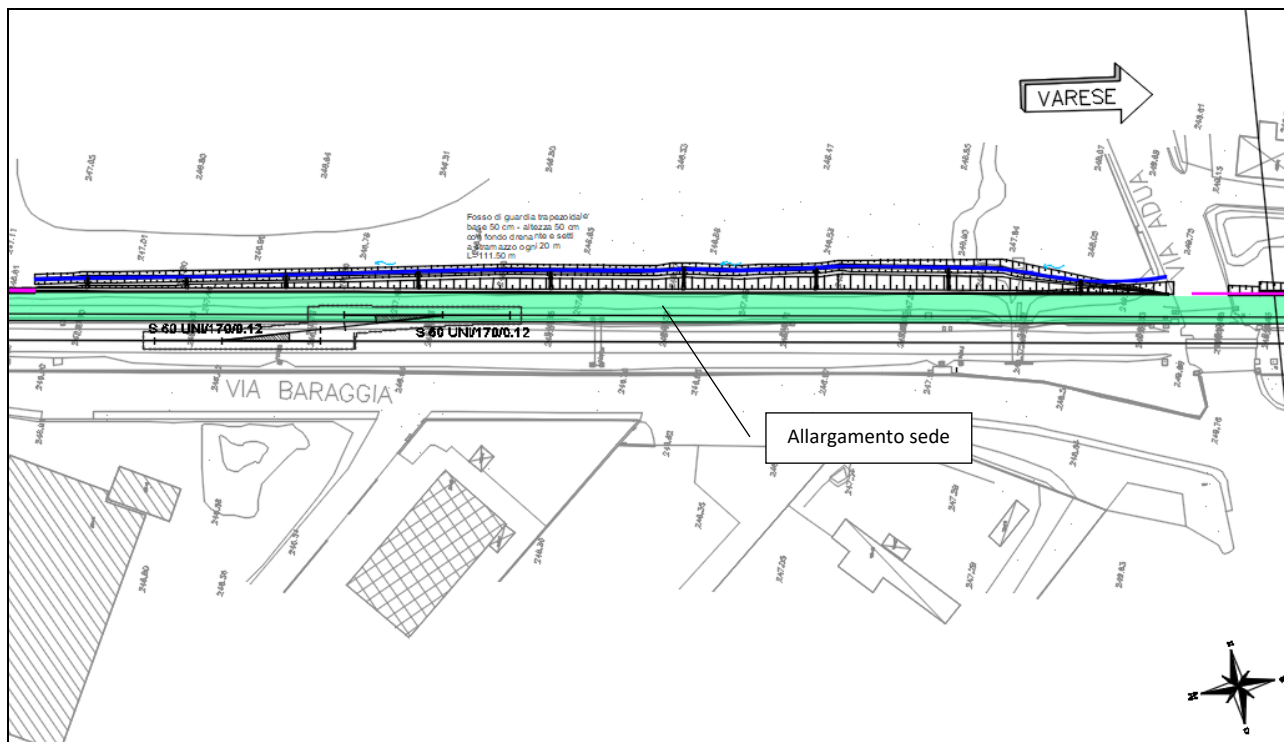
Stralcio planimetrico della sistemazione idraulica dopo PL di via Adua
